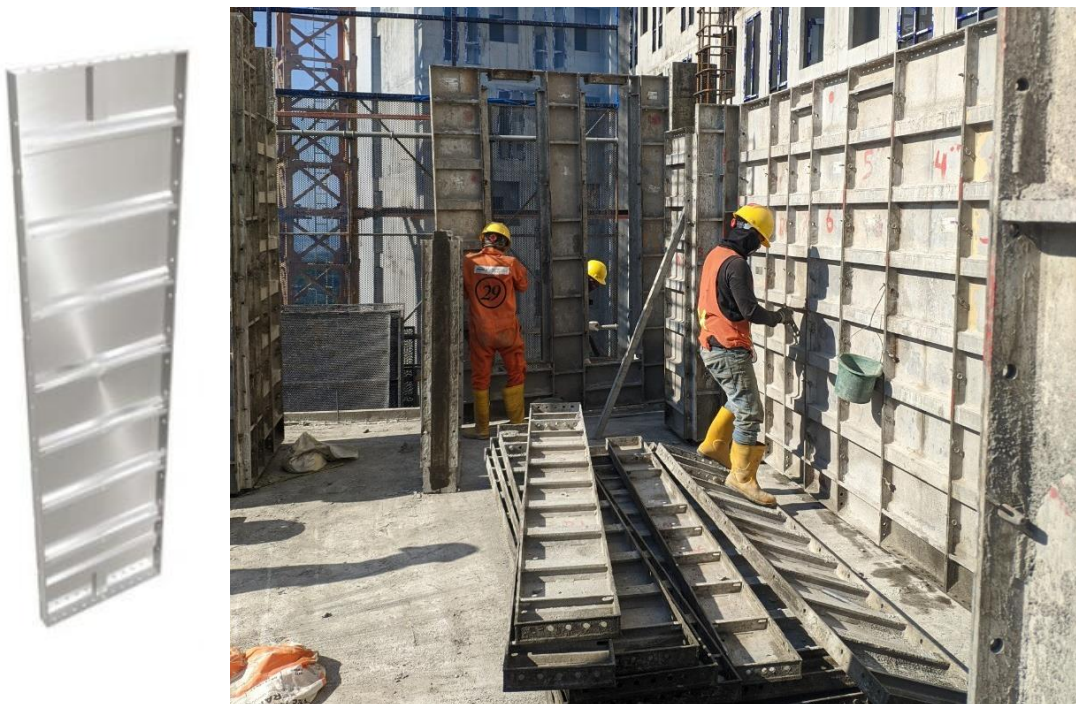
Pemindahan bekisting dari lantai bawah
